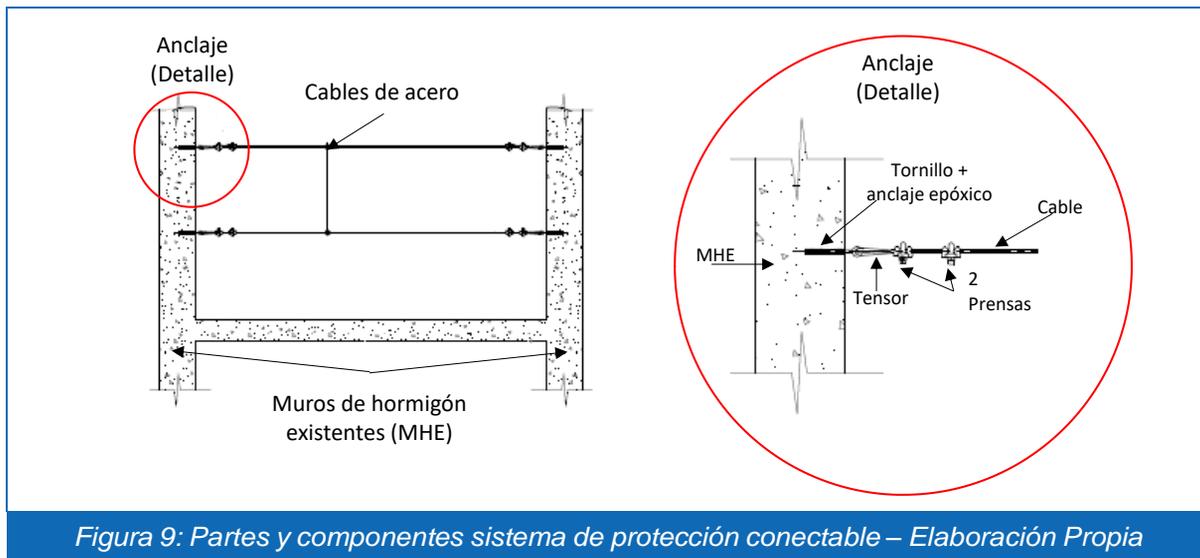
Partes y componentes sistema de protección conectable – Elaboración Propia
